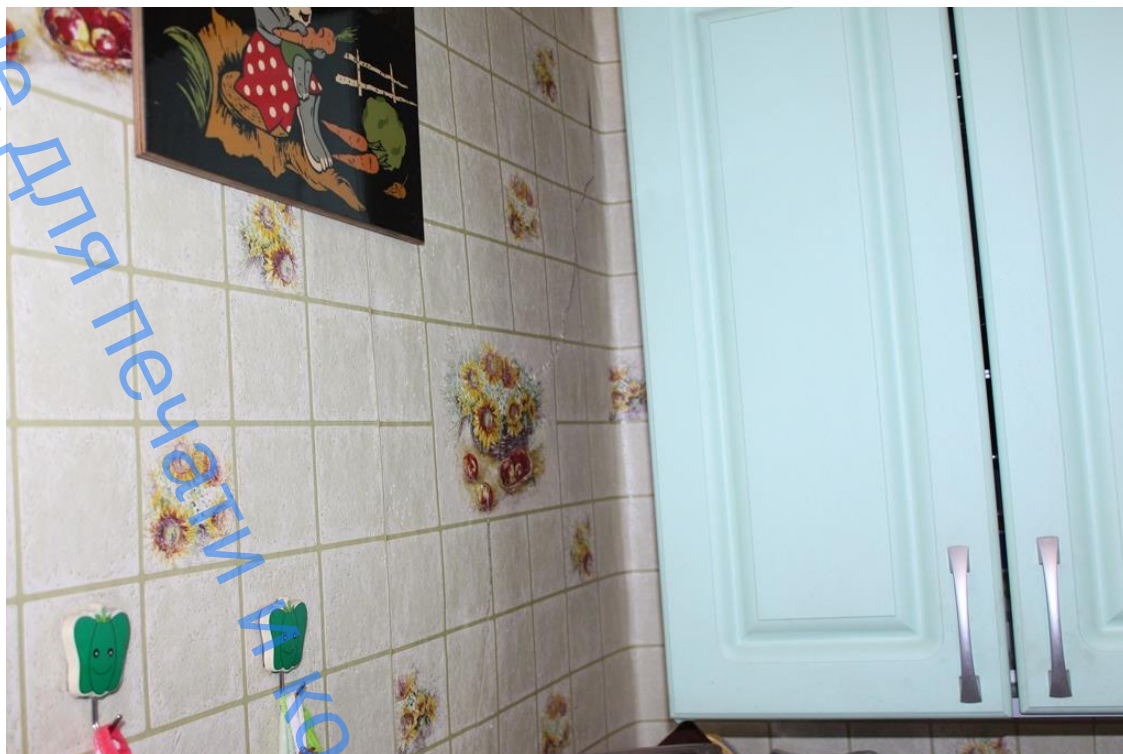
Трещина по оси В между осяй 1 и 2 (стена внешняя между перекрытием первого и второго этажей, квартира 12)
